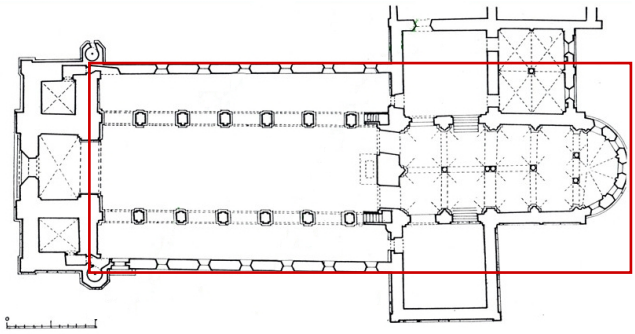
Grundriß² des Brandenburger Doms mit Grundrechteck (rot), dessen Seiten sich wie 13:5 verhalten.
